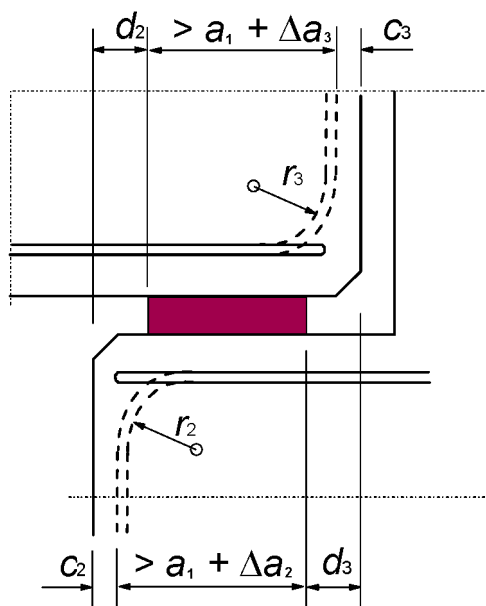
Ejemplo de detalles constructivos de armadura en apoyos
